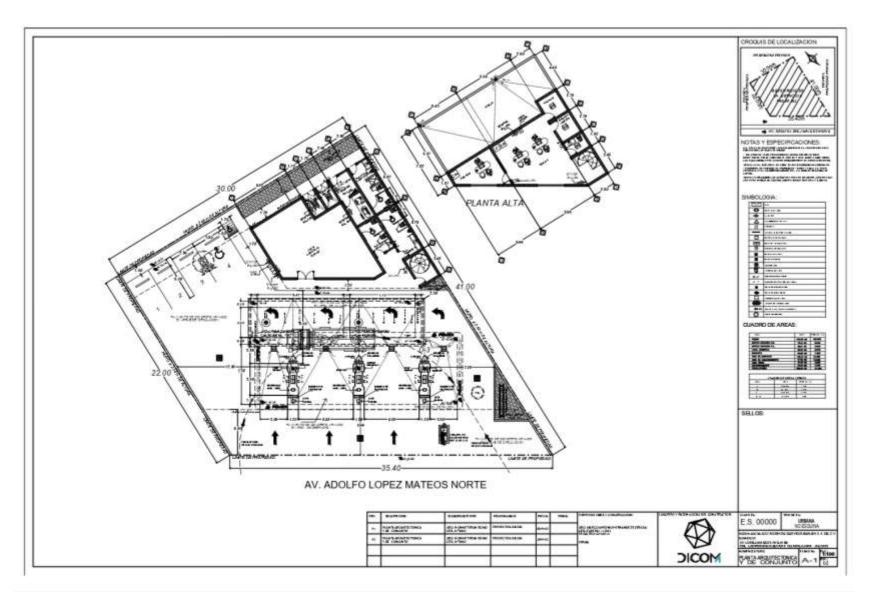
Imagen del plano A-1 planta arquitectónica y de conjunto proyectado.
